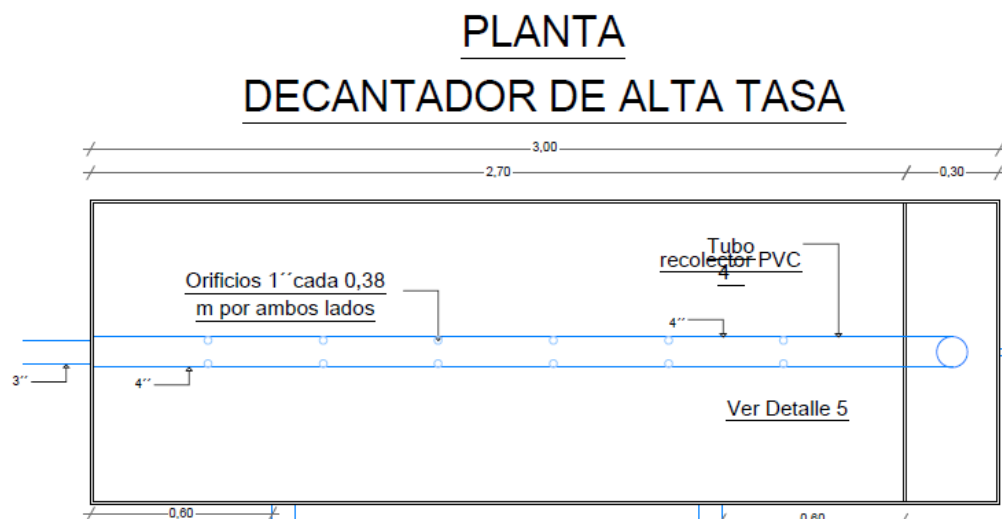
Vista superior de planta del sedimentador propuesto para el tratamiento
